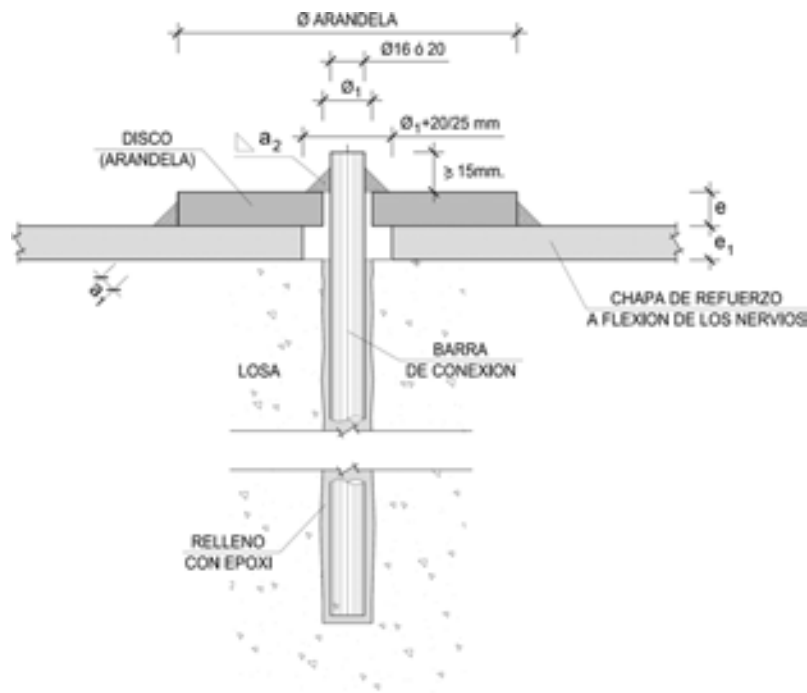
Detalle de conexión de chapa de refuerzo a flexión de la losa
